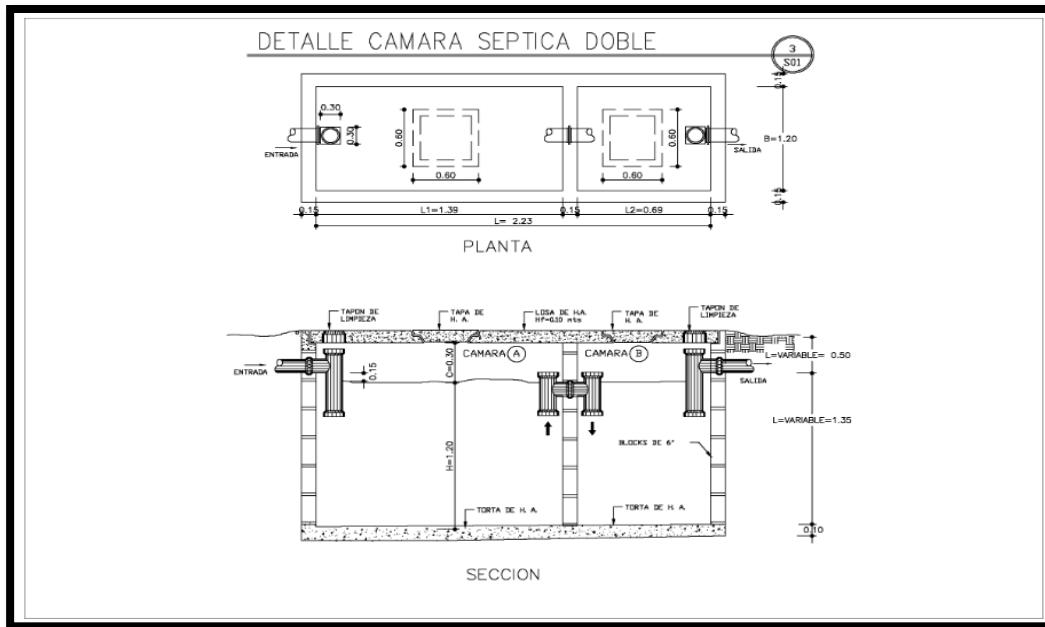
Diseño planta de tratamiento (PTAR) que se construirá
